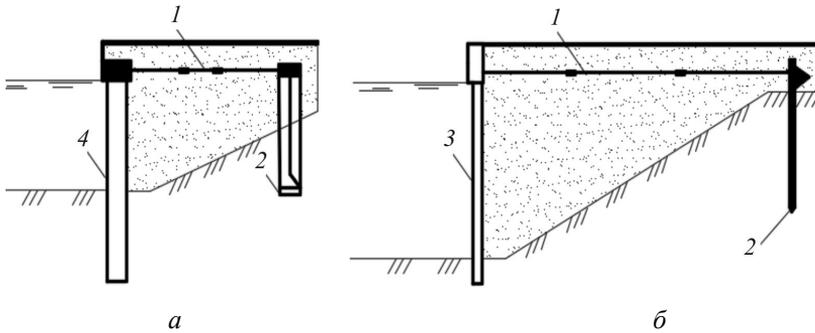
Пример причального сооружения из заанкеренного больверка из свай-оболочек (а); то же, из шпунта (б); 1 – анкерная тяга; 2 – анкерная плита (стенка); 3 – шпунт; 4 – колонна-оболочка
